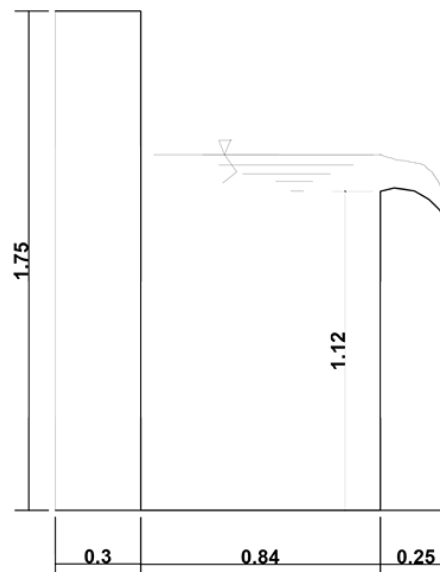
Corte transversal B-B de la estructura de la mezcla rápida (Real)
